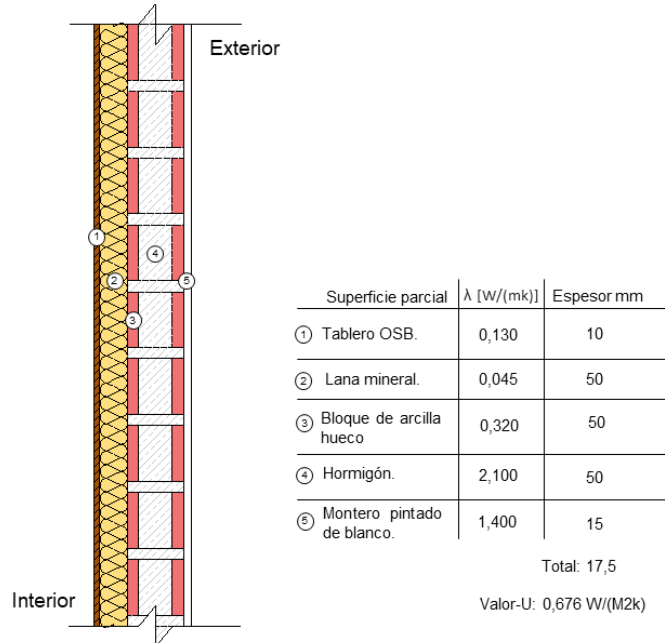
Detalle de solución constructiva para muro de fachada. Fuente: elaboración propia.
